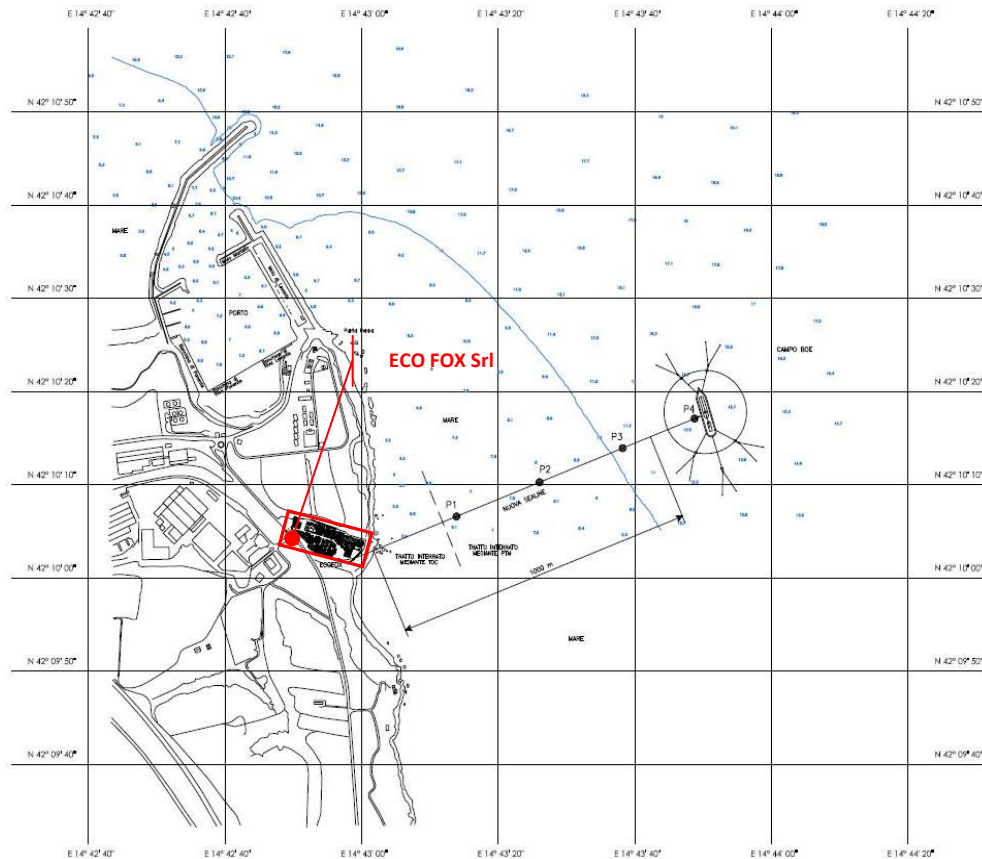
Planimetria con posizionamento condotta e campo boe
